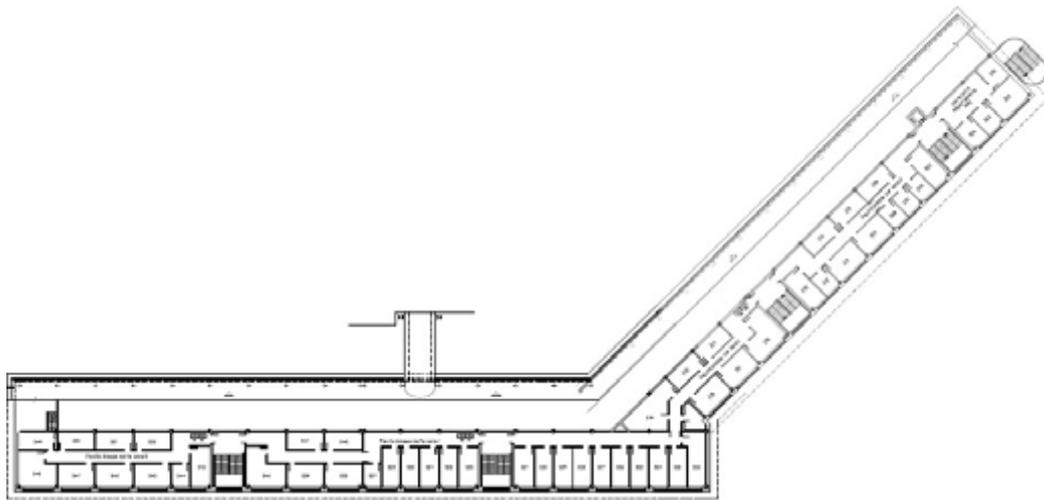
Vista en planta de los espacios en la sede campus de la EEI (Edificio II – Zona III)
